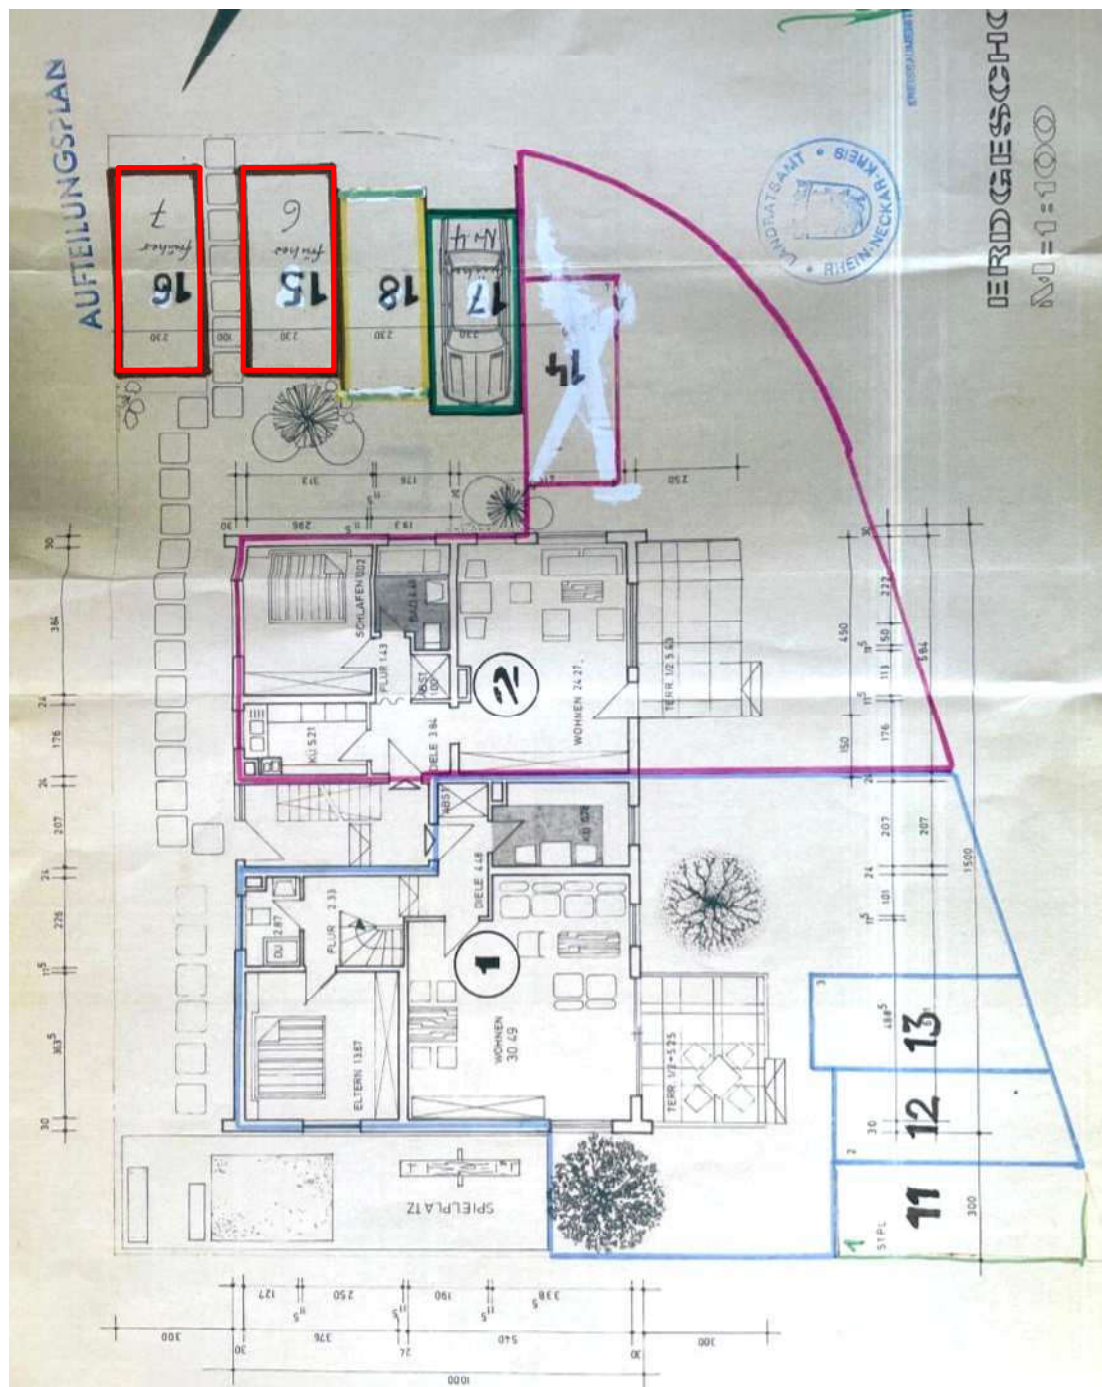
Grundrissplan Erdgeschoss und Freiflächenplan
